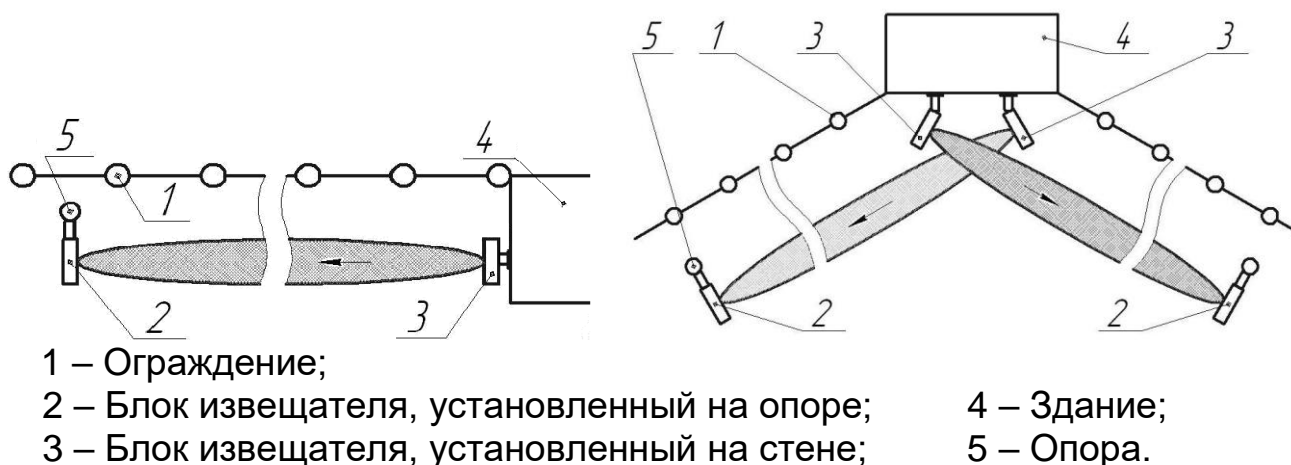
Примеры установки блоков на стенах зданий
